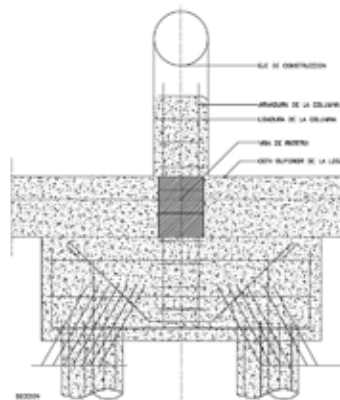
Detalle de Cabezal para tres Pilotes (Sección), fuente: La Autora (2017).
